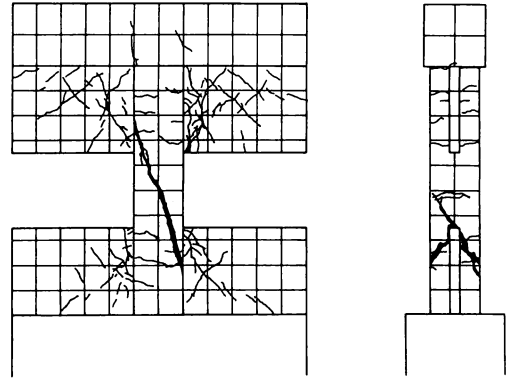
(d) 試験体 CSS04 の最大耐力時のひび割れ図
